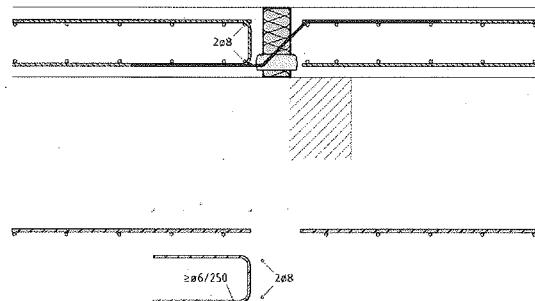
Bewehrungsführung Q bei direkter Lagerung und deckenseitig geraden Querkraftstäben
